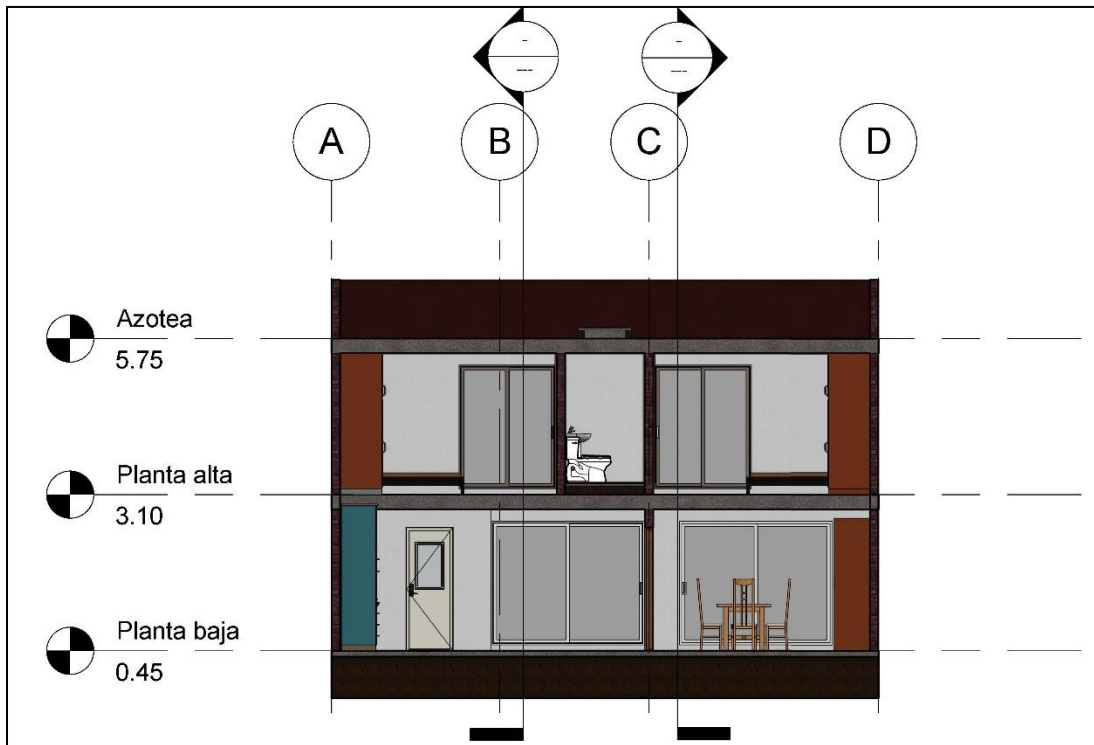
Plano de vivienda no sustentable: sección transversal 01. Fuente: autoría propia
